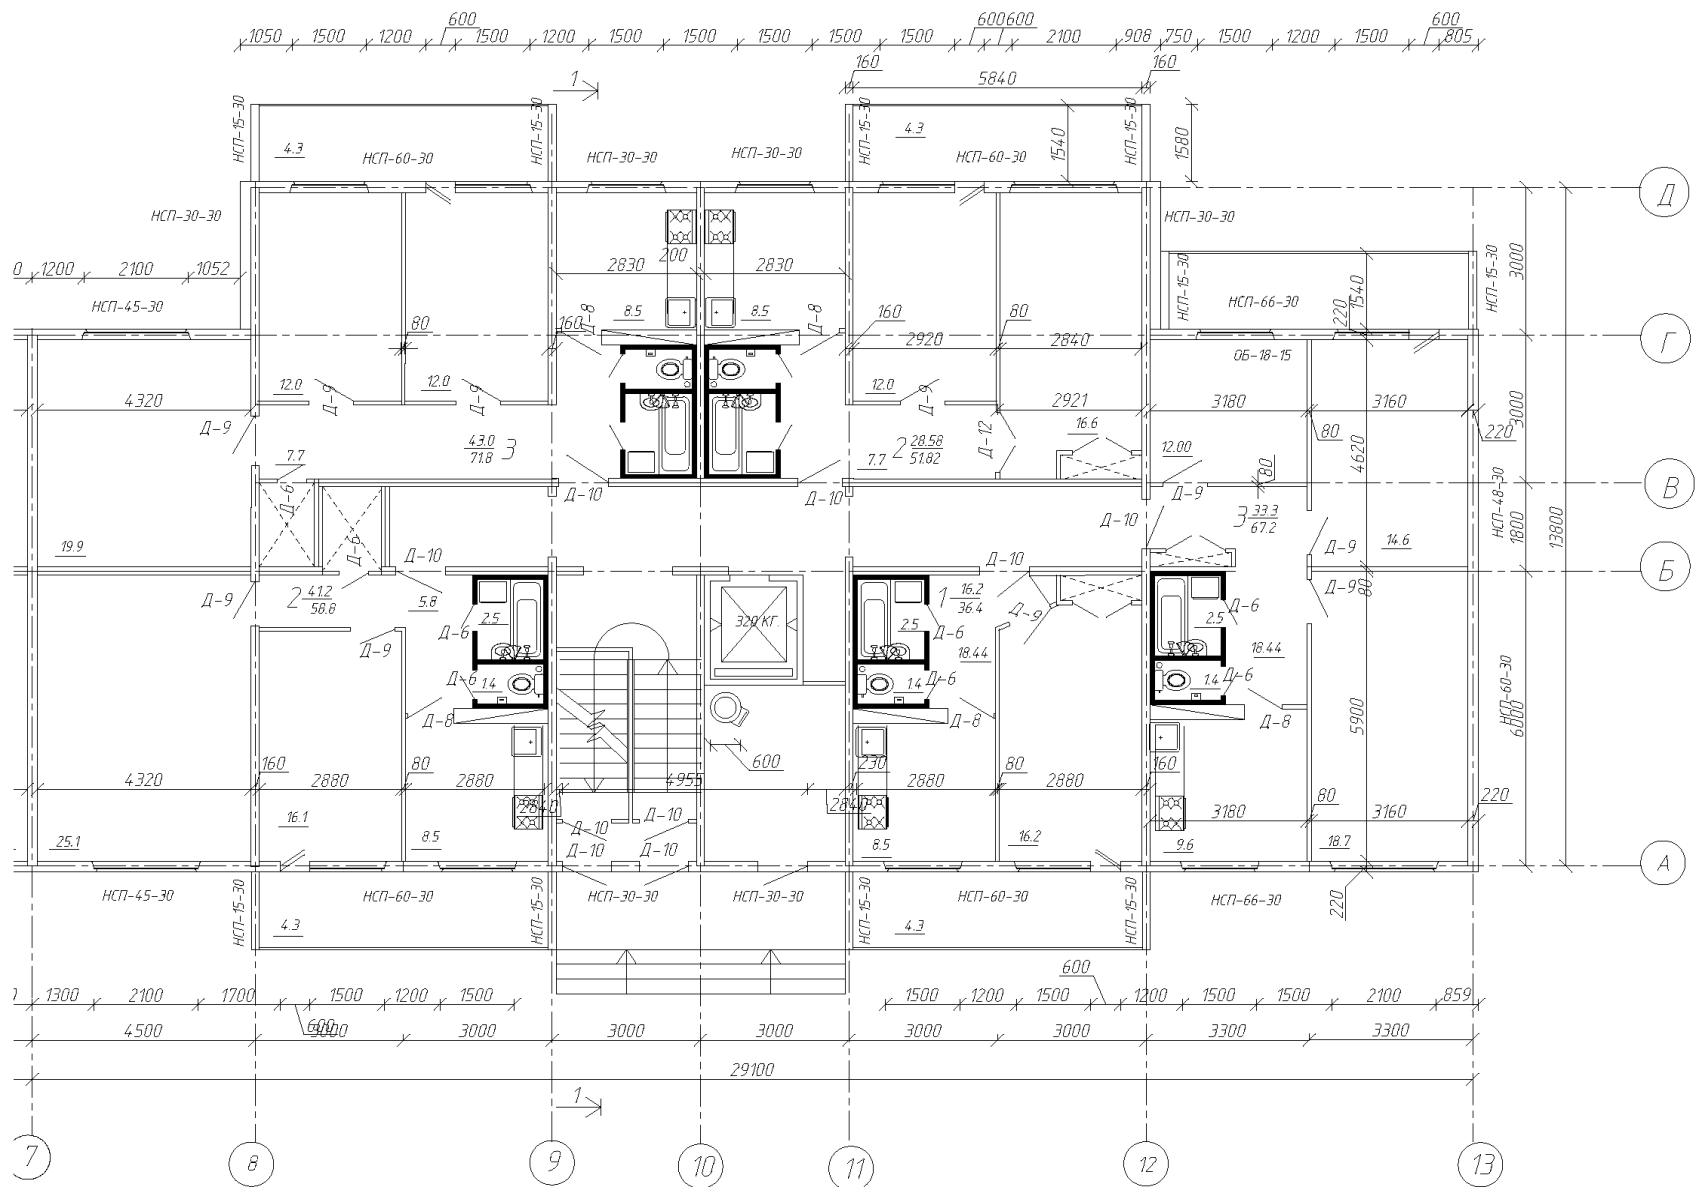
Образец выполнения плана 1-го этажа жилого здания
